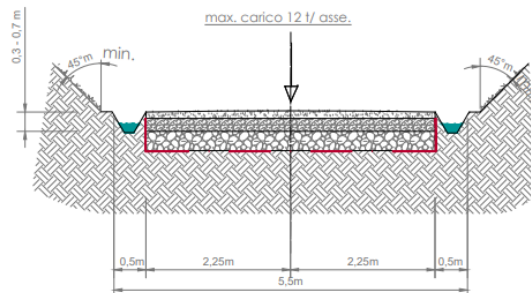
Sezione stradale tipo nel caso di allargamento della sede stradale esistente
